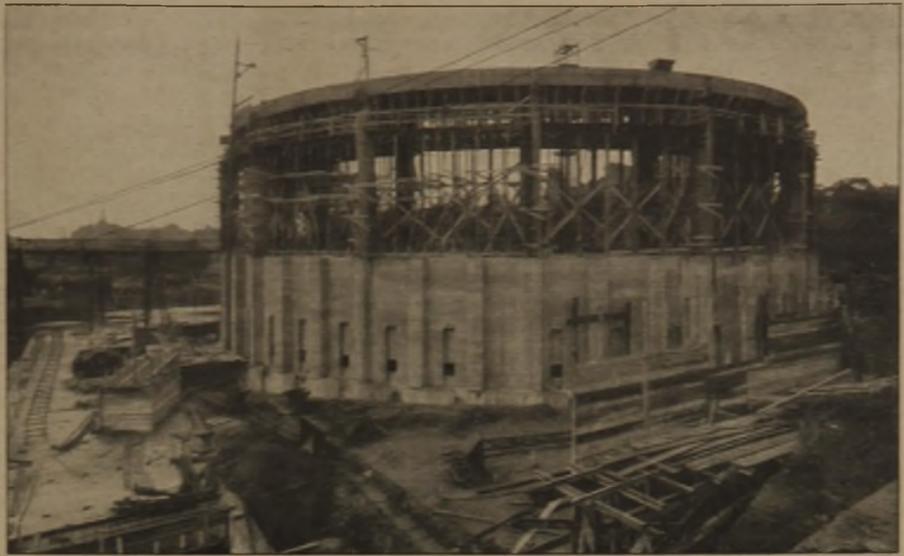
Rundbau vor Beendigung der Betonierungsarbeit.
